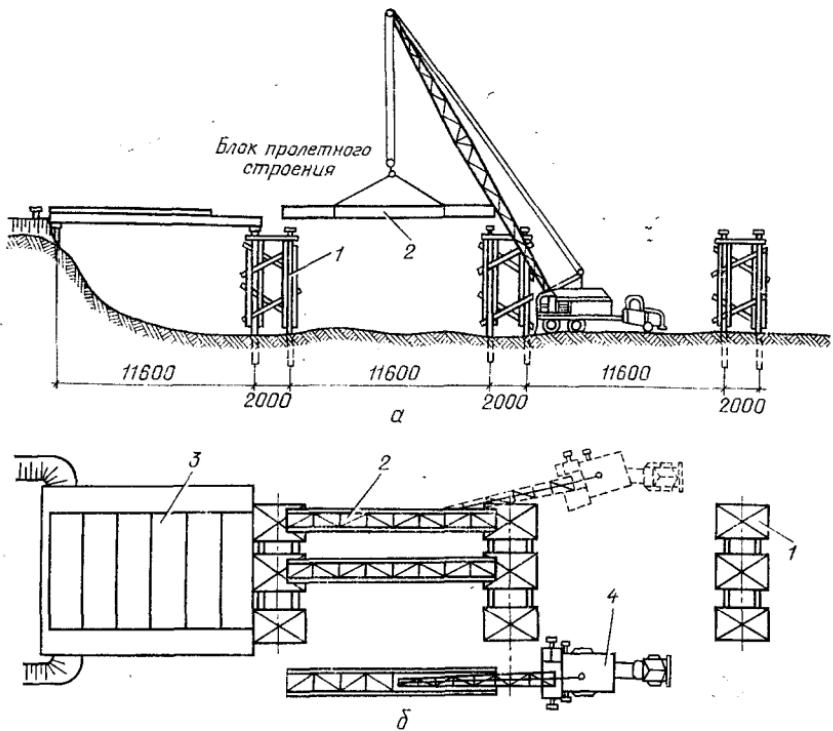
Схема монтажа металлических пролетных строений на суходоле:
